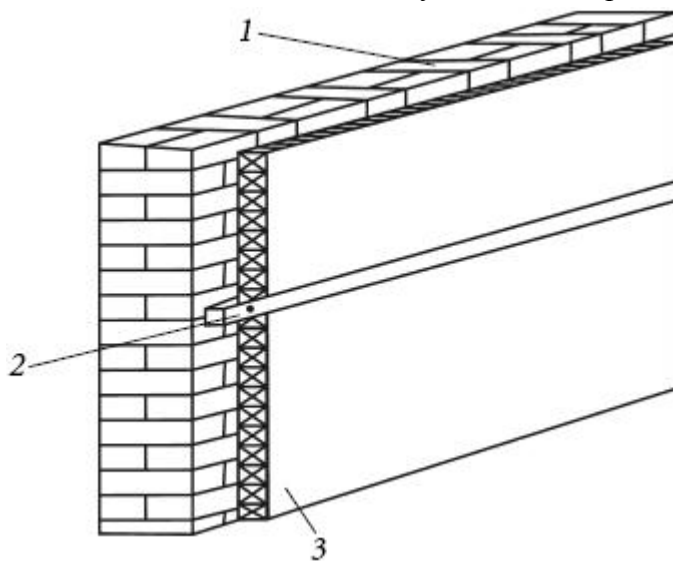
Внутренняя теплоизоляция каменных стен плитным материалом: 1) кирпичная кладка; 2) деревянные рейки; 3) плиты утеплителя
